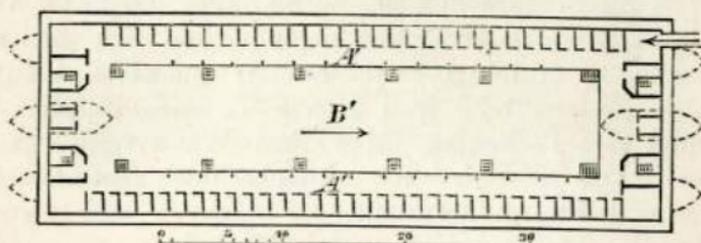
Thiebe'sche schwimmende Badeanstalten im Rhein zu Bonn (Grundriss des Herren-Badeschiffs).
